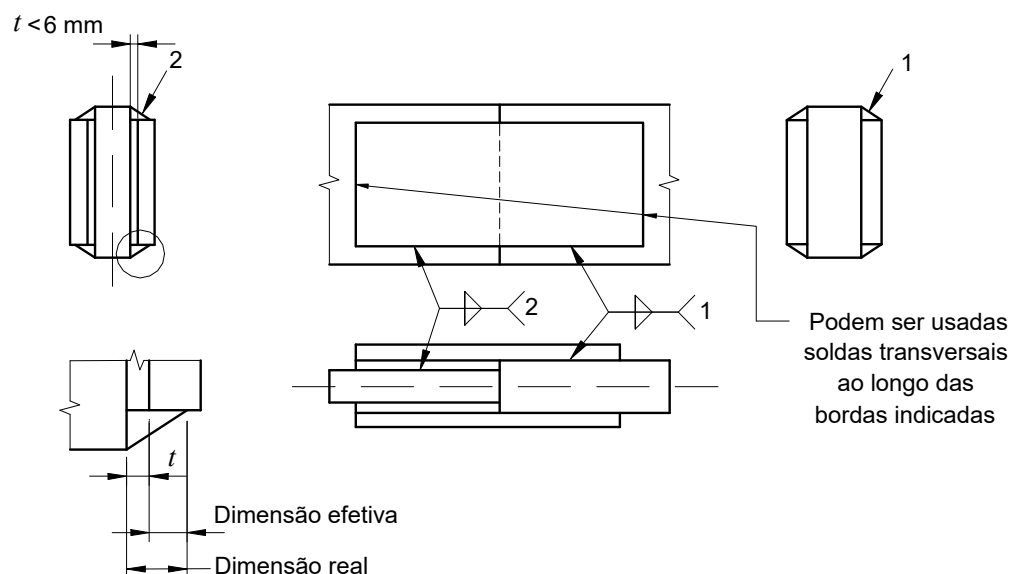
Chapa de enchimento com espessura inferior a 6,3 mm
